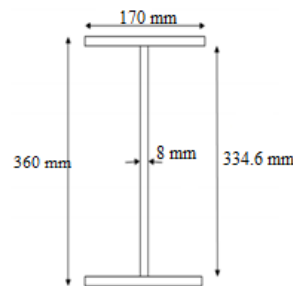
Dimensions de la section au niveau de l'assemblage avec poteau
